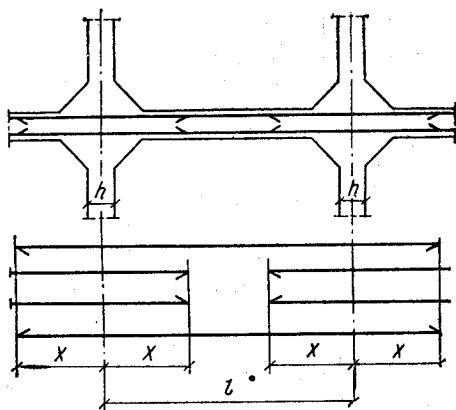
Схема армирования стен квадратных монолитных силосов
